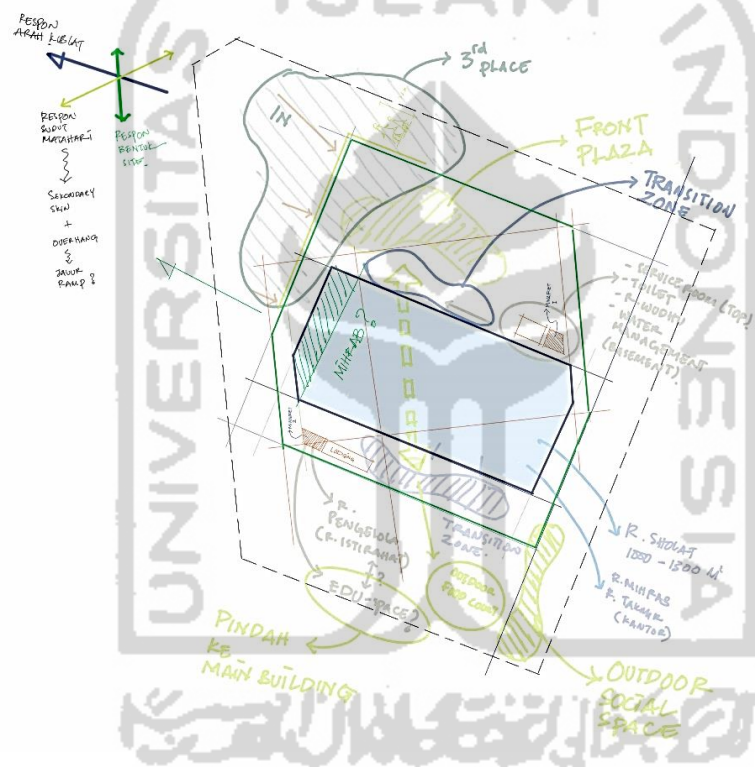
Eksplorasi Plotting Denah dan Siteplan
